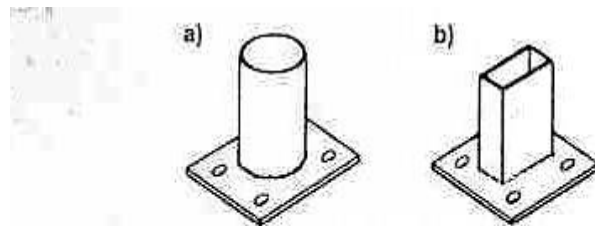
Columna de un solo ple soldada a la placa base a) CHS b) RHS
